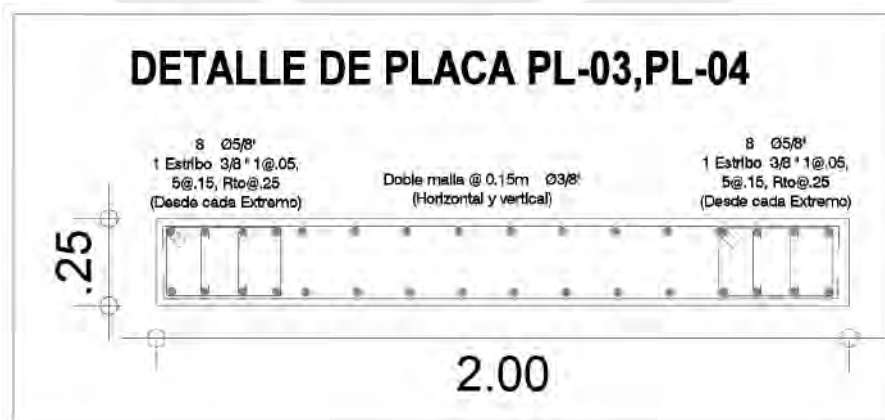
Detalle final de la placa PL-03 y PL-04, segunda propuesta de reforzamiento
